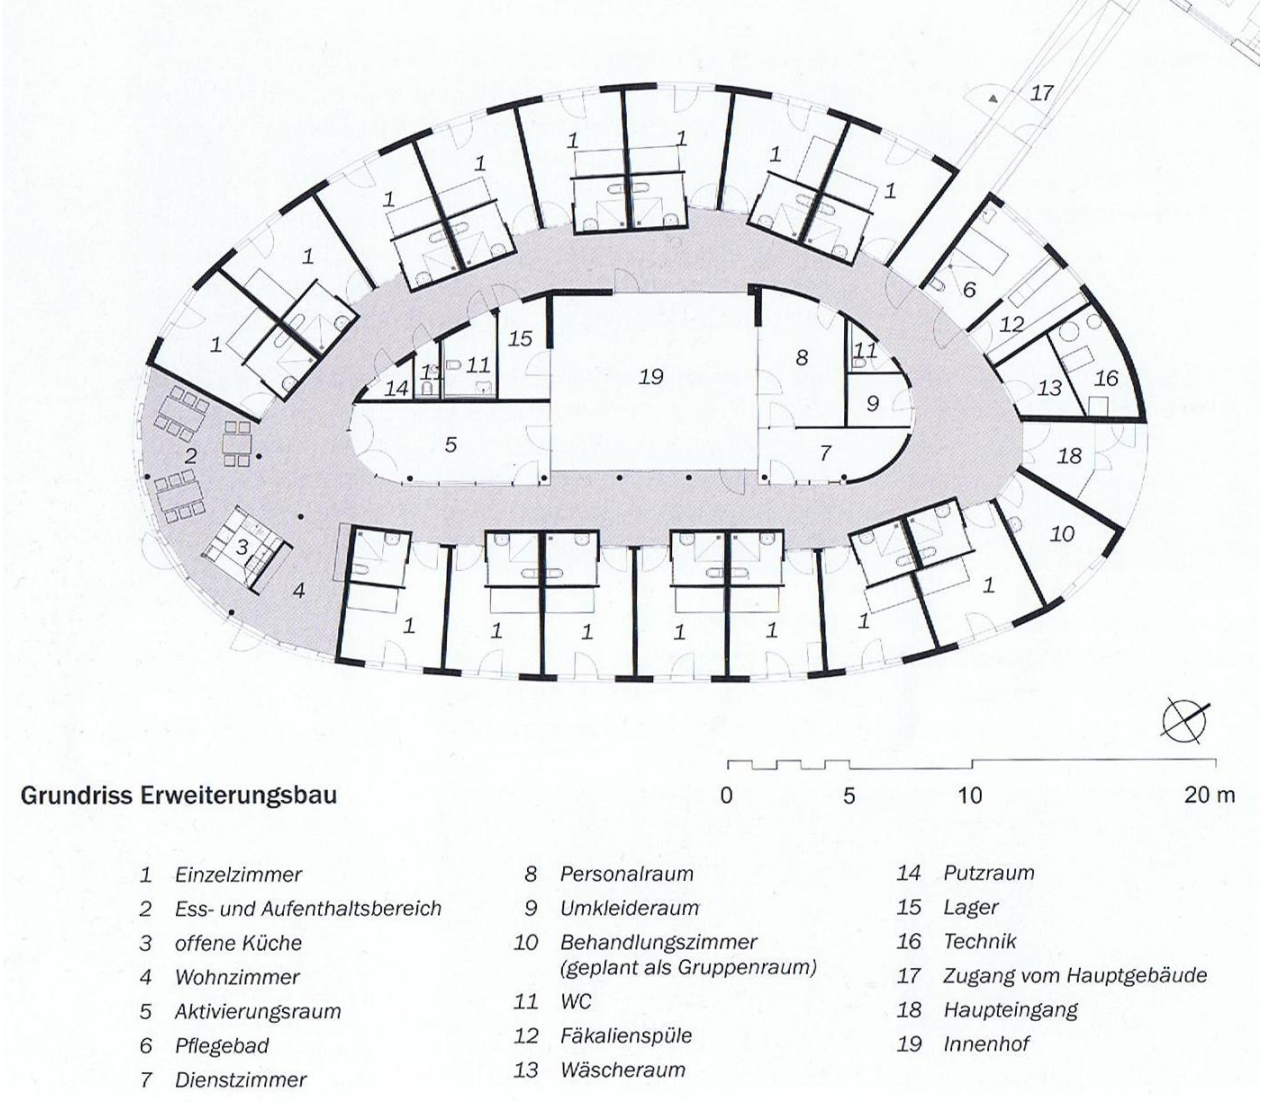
Grundriss Erweiterungsbau, Heim Bad Schussenried
